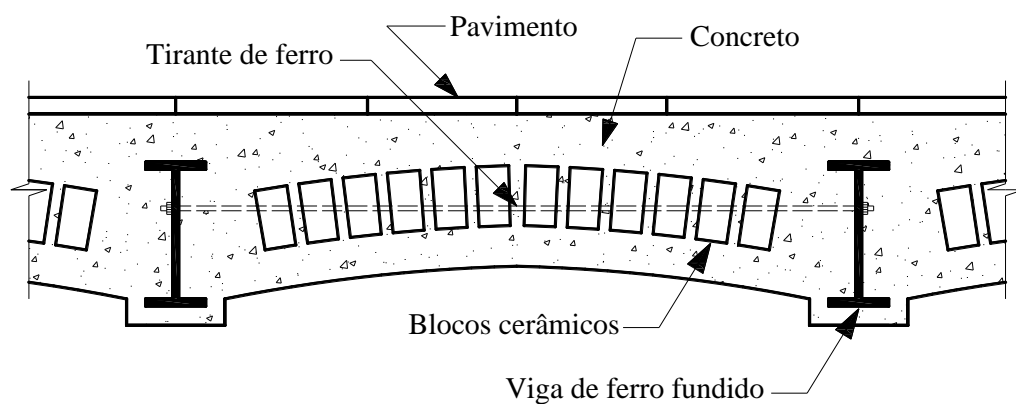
Sistema *jack-arch floor* (Adaptado de BARROS, 2011).
